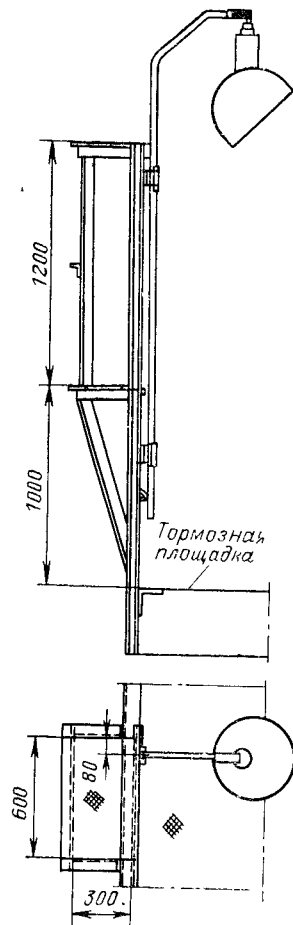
Площадка для доступа к светильникам, установленным на ограждении тормозных площадок открытых эстакад.
